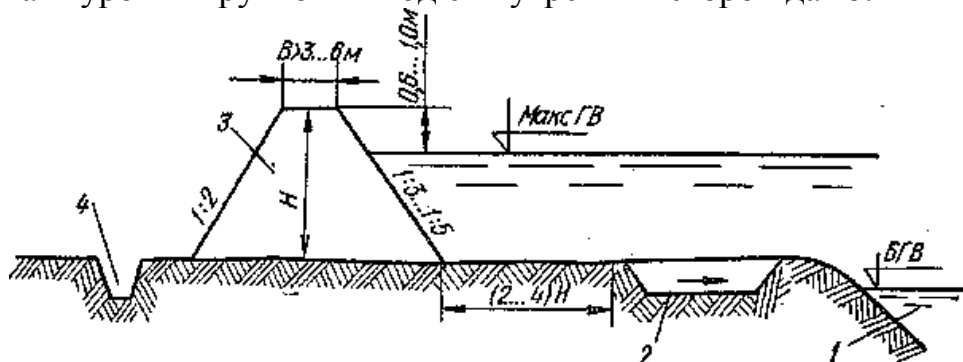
Поперечное сечение незатопляемых дамб:
